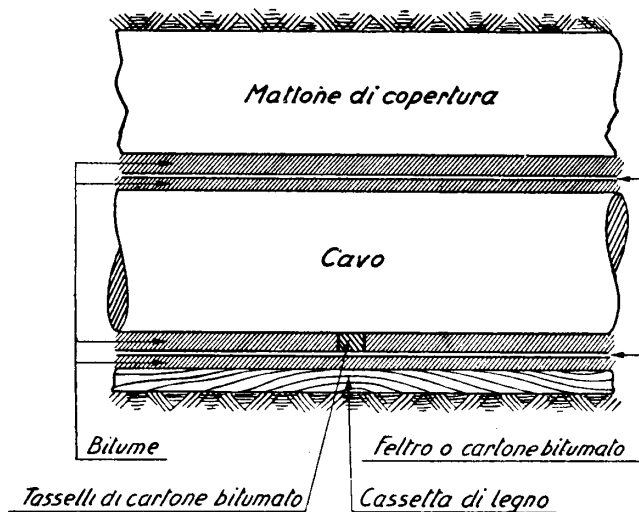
Cassetta tipo « Panara »; sezione longitudinale.
